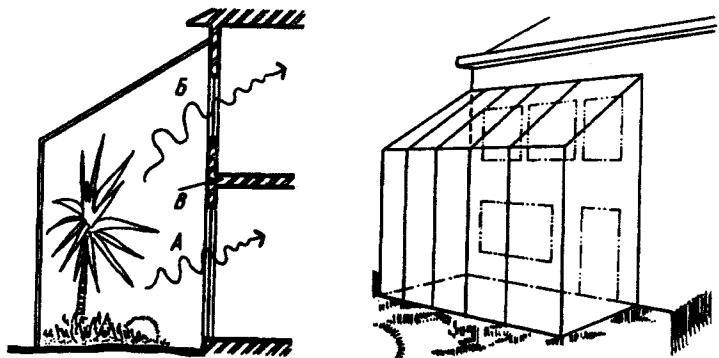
Оранжерея высотой в два этажа около наружной стены дома
